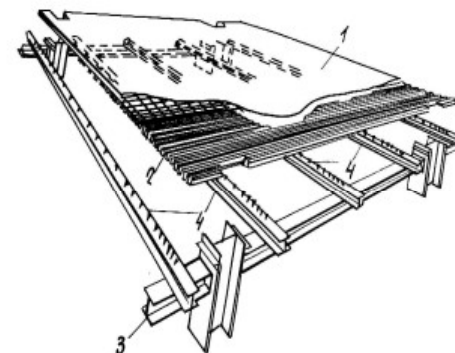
Перекрытие, выполненное по 1-й конструктивной схеме:
